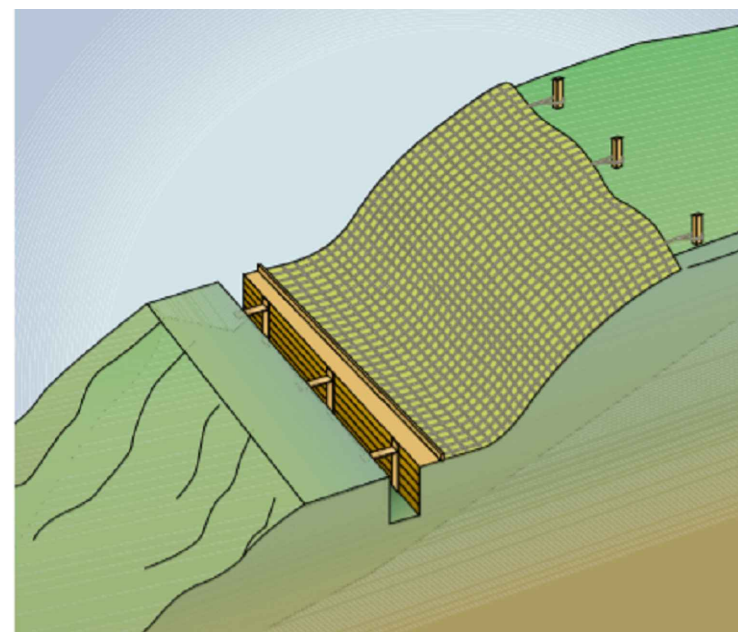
Escavação mista – com paredes em taludes e com paredes protegidas por cortinas
